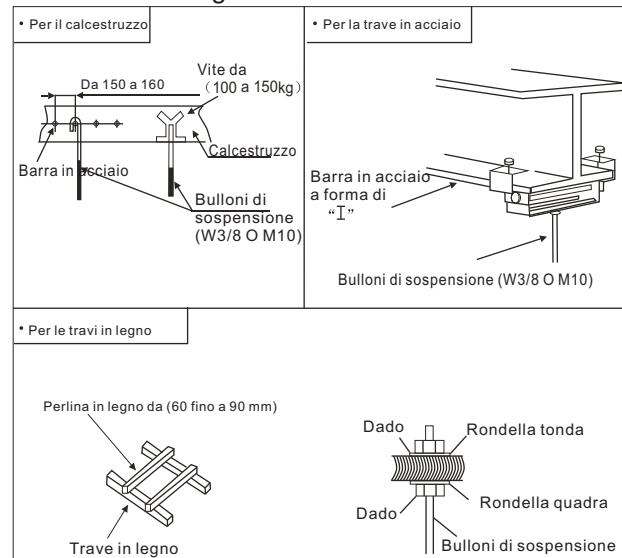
Fissaggio dei bulloni di sospensione
